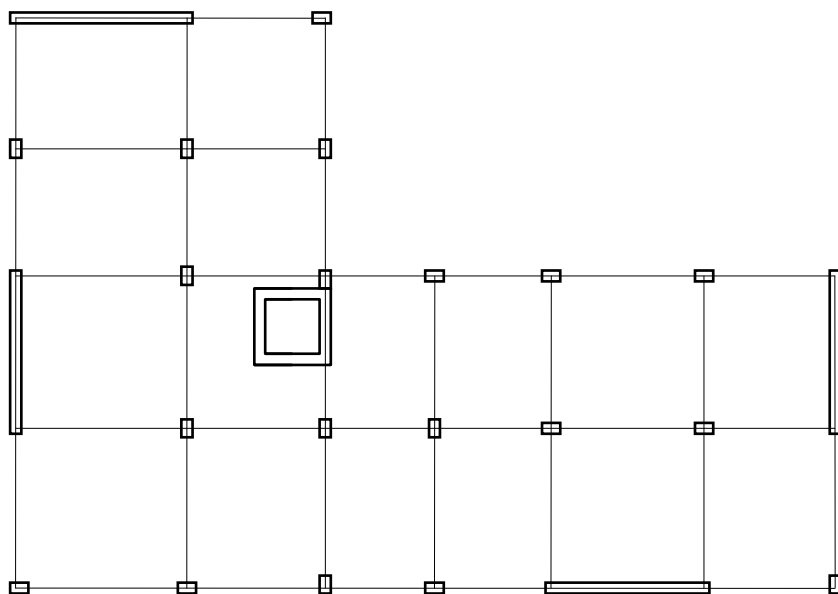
Schema della carpenteria con posizionamento di pareti e pilastri
